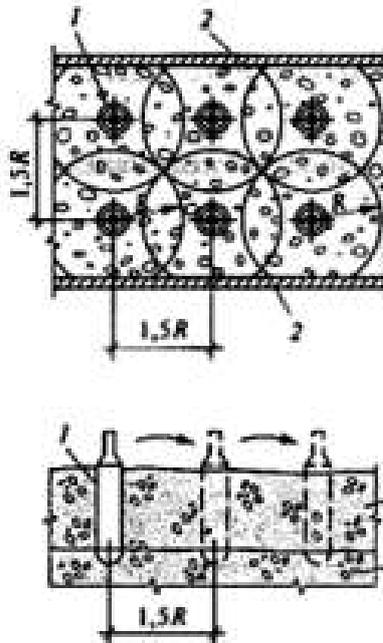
Уплотнение бетонной смеси: 1 – рабочий орган вибратора; 2 – опалубка; 3- укладываемый слой бетона; 4 – ранее уложенный слой бетона.
